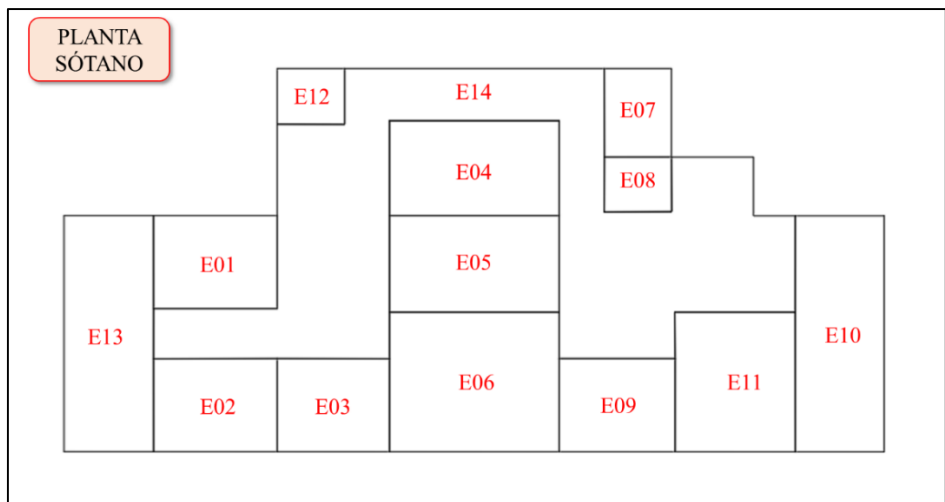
Zonificación de la planta sótano. Fuente: Elaboración propia.
